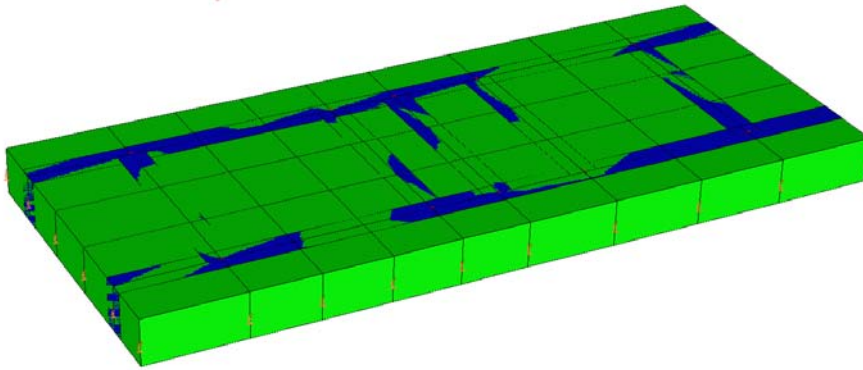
Vista 3D Platea di Fondazione con Travi di Collegamento
